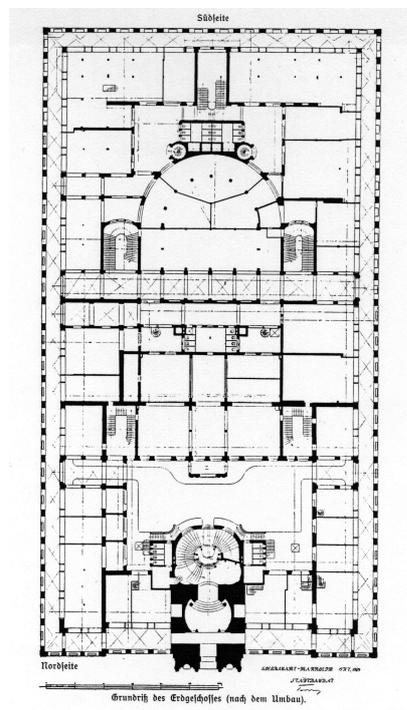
Grundriß des Erdgeschosses nach dem Umbau
